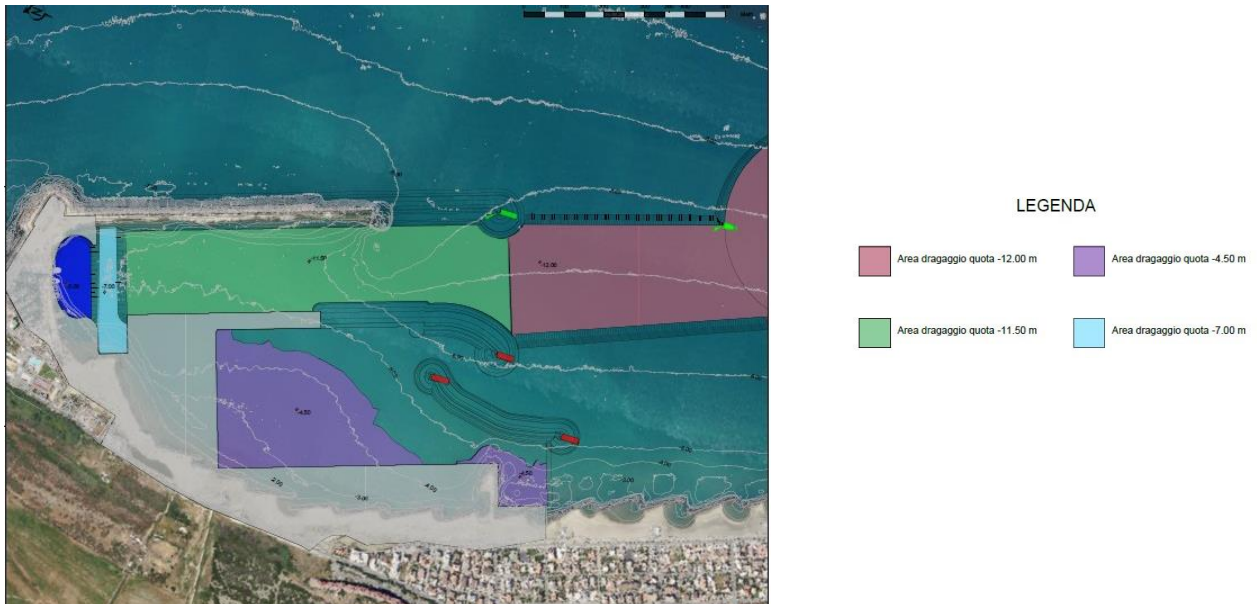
Planimetria dragaggi – reinterri di progetto
